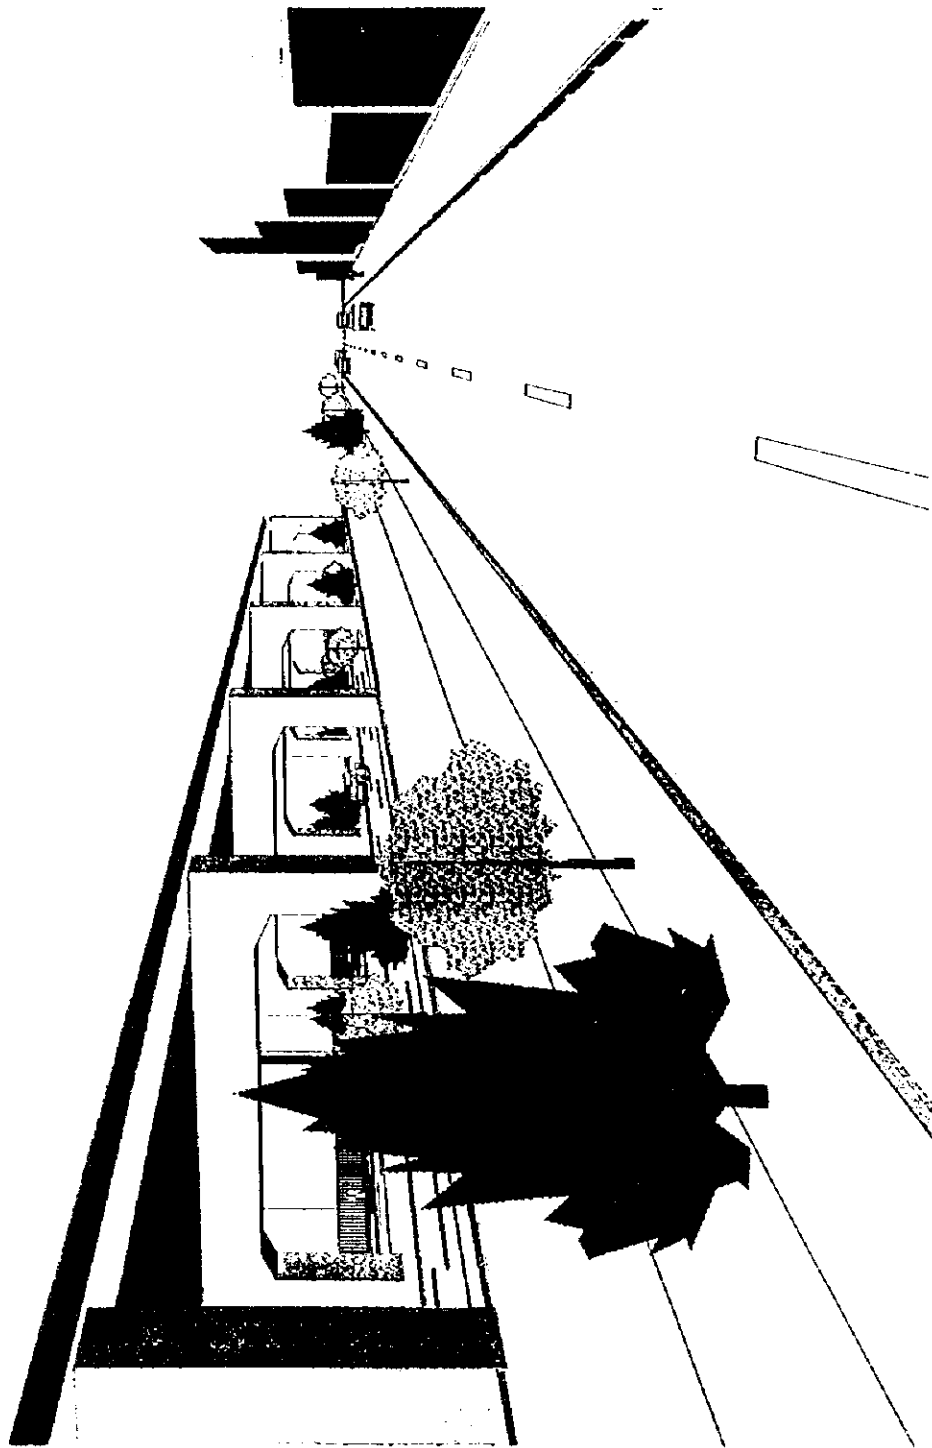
Plano tridimensional de la Alternativa B sobre la Avenida Quito (2)
